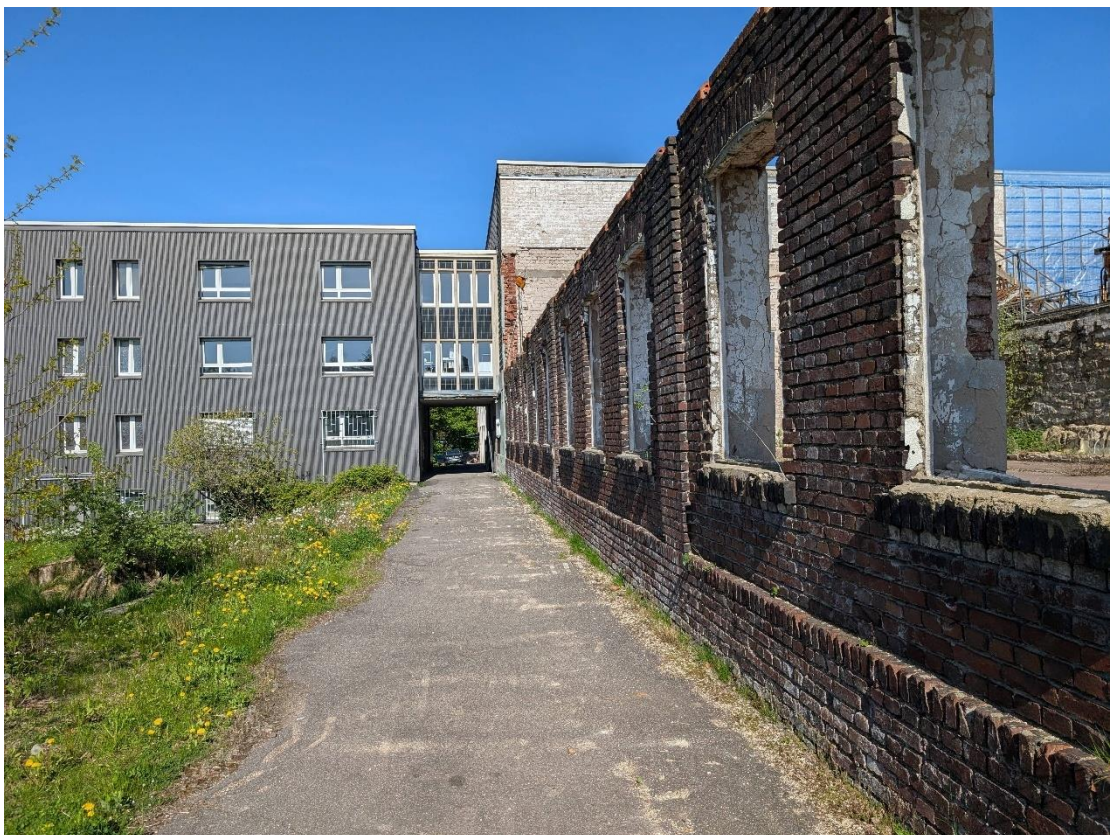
Zentrum des Plangebietes; eingestürzte Gebäudeteile und intakte Strukturen im Hintergrund; rechts: Wiesenfläche
